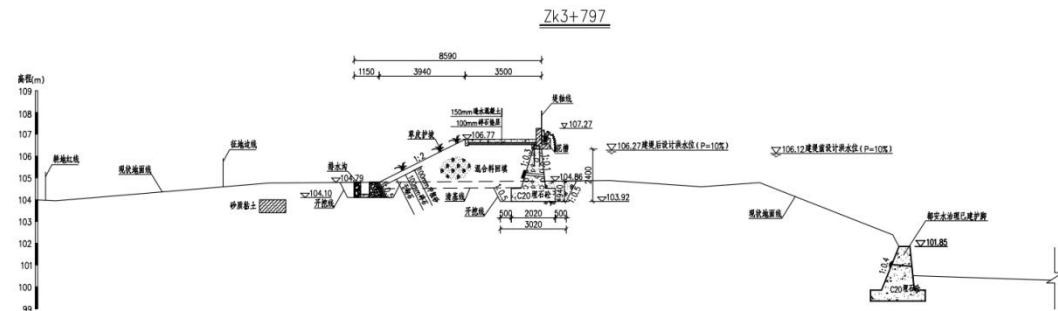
草皮护坡+混凝土挡墙 2.4m
